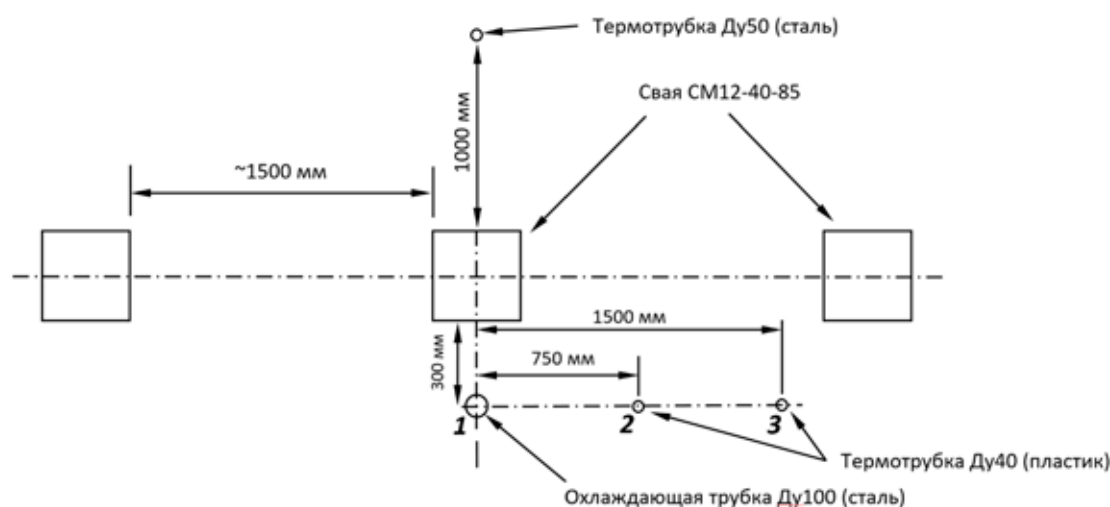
Схема расположения охлаждающей трубы (1) и термотрубок (2, 3) относительно испытываемой сваи
